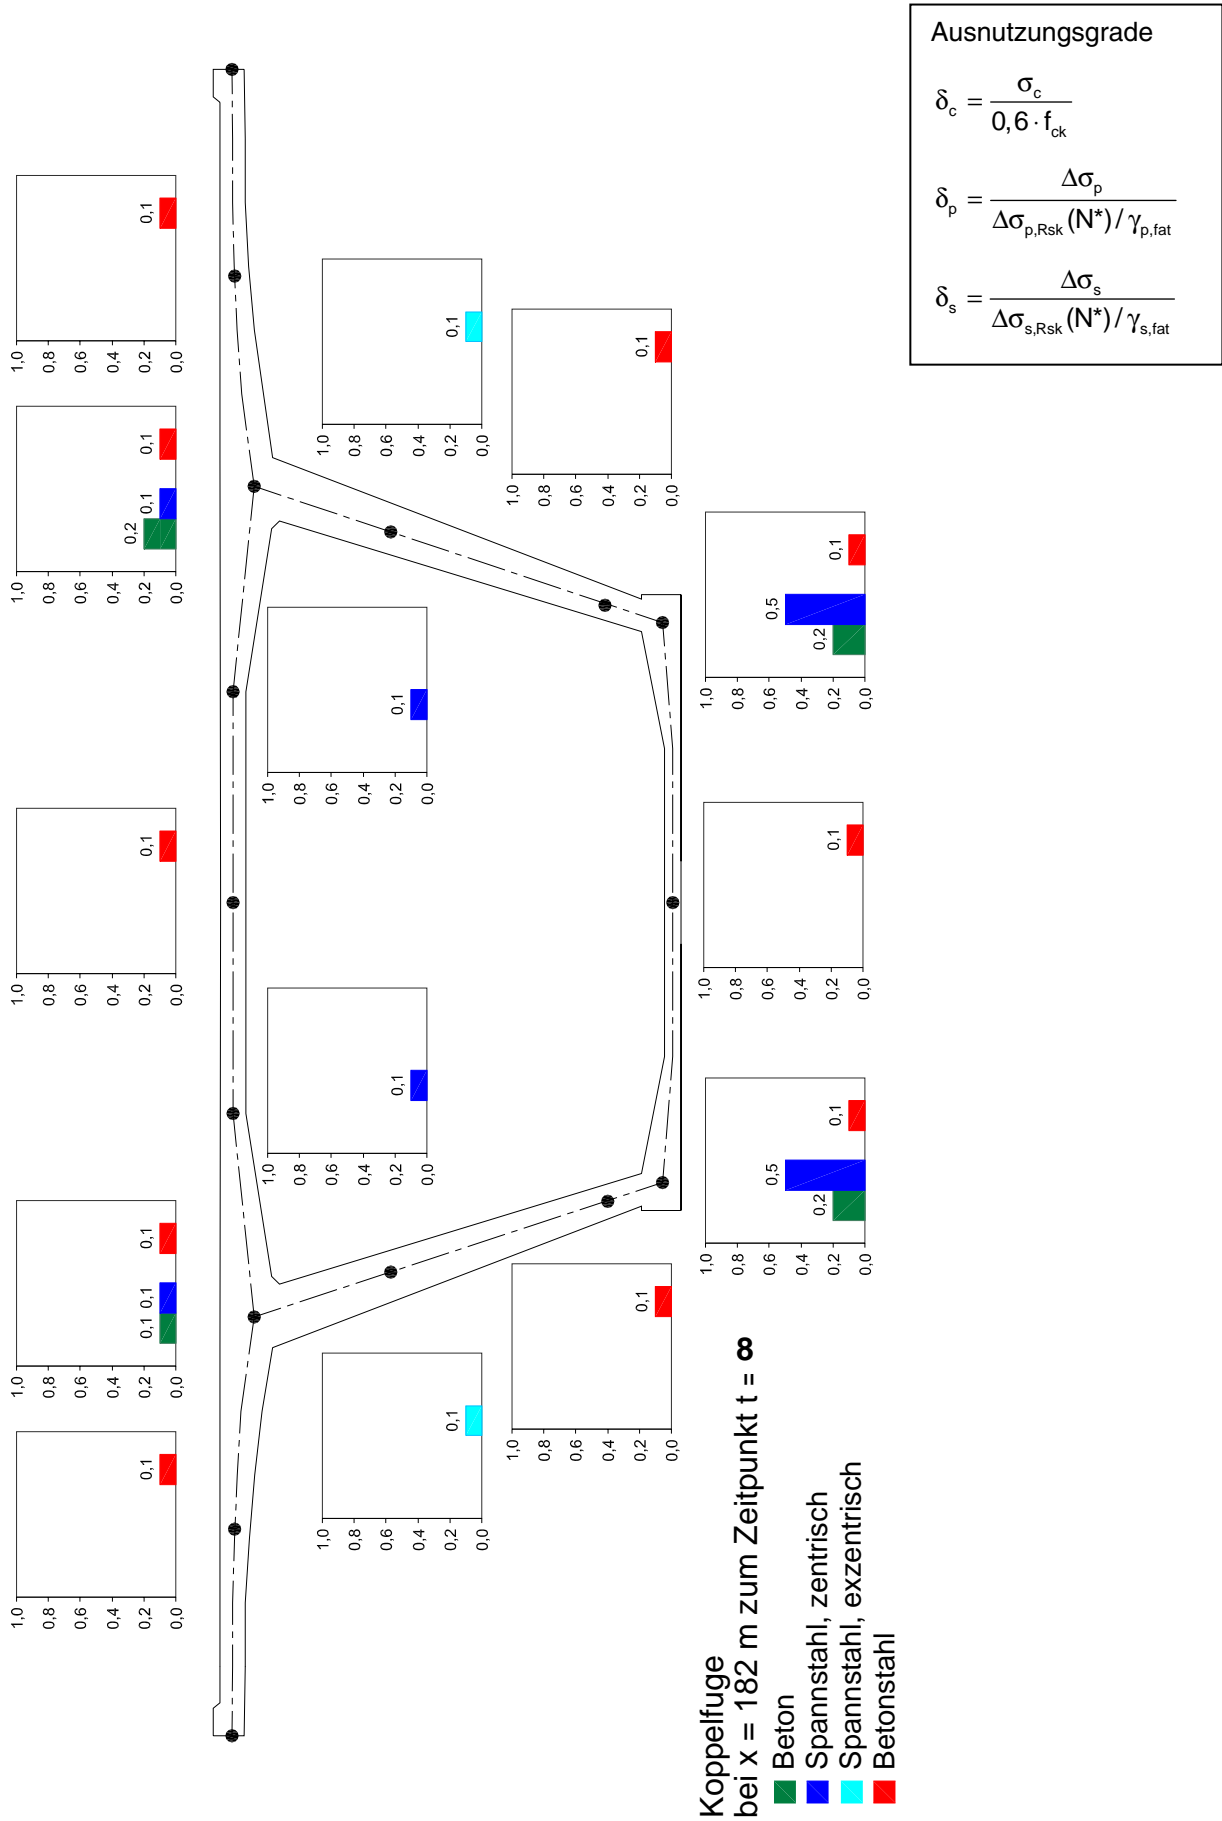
Ausnutzungsgrade des Betons δ_c , Spannstahls δ_p und Betonstahls δ_s .
